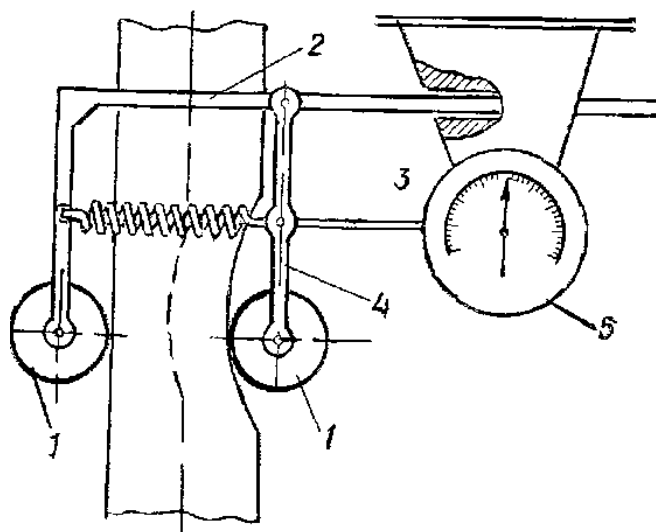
Передаточный механизм для измерения расстояний между осями рельсов
